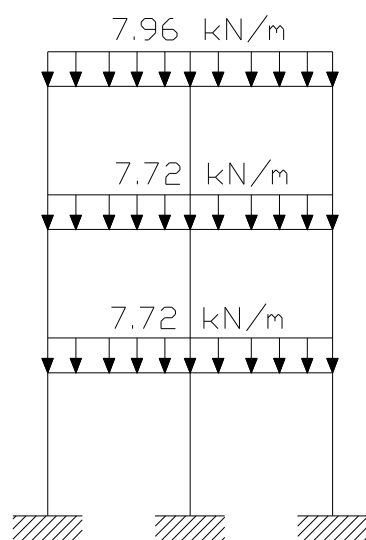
Carregamento Permanente, Composto pelo Peso da Estrutura Metálica e Peso do Concreto das Lajes.
